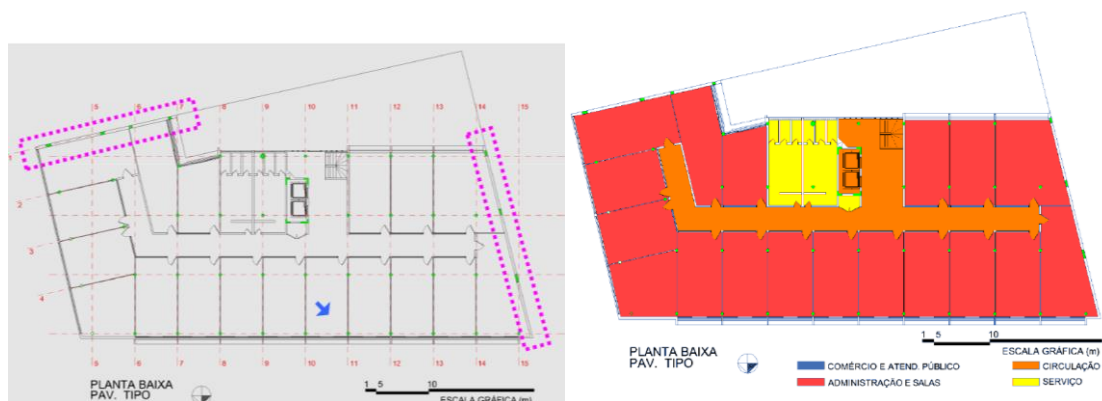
e 24: Elementos verticais da fachada do IPASE.
